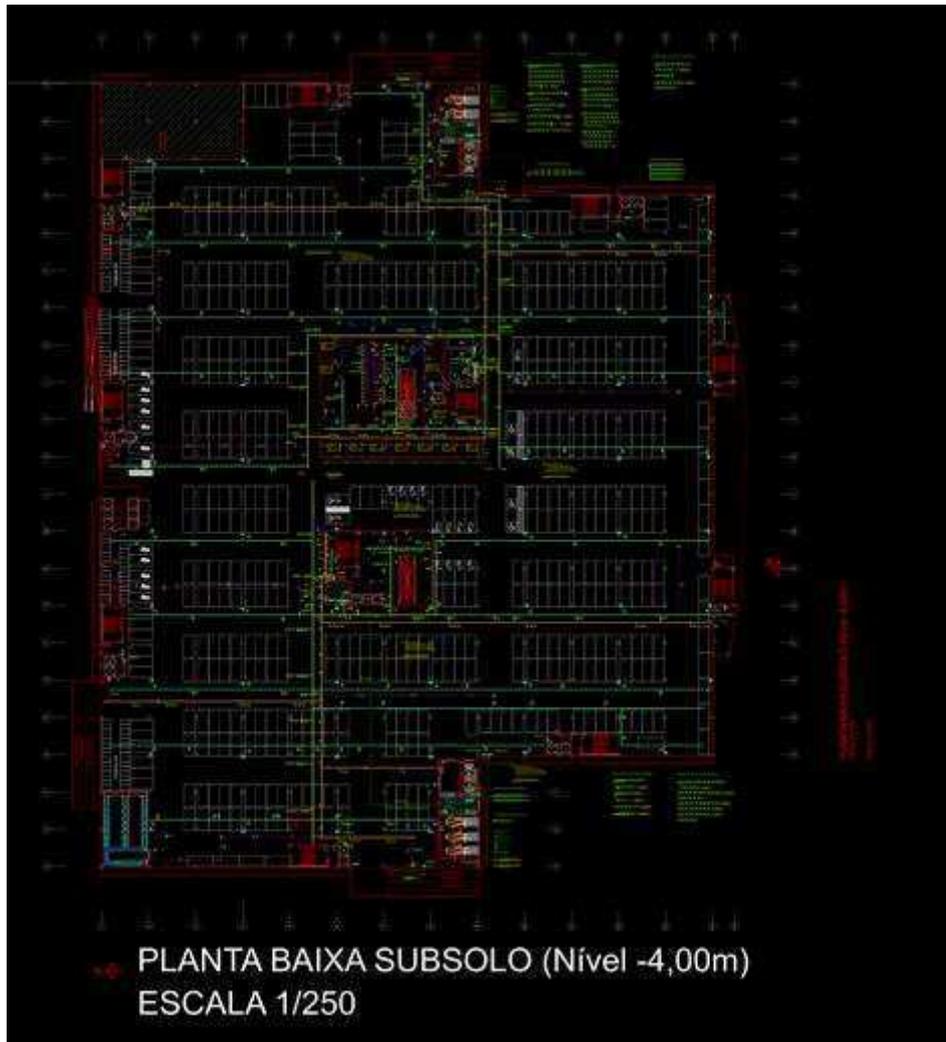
B. Planta baixo subsolo: Projeto elétrico.
